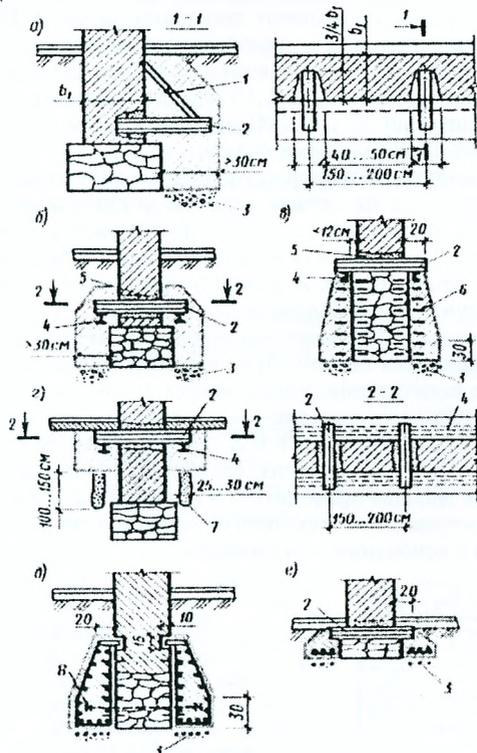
Технология усиления фундаментов с опрессовкой грунтов основания
